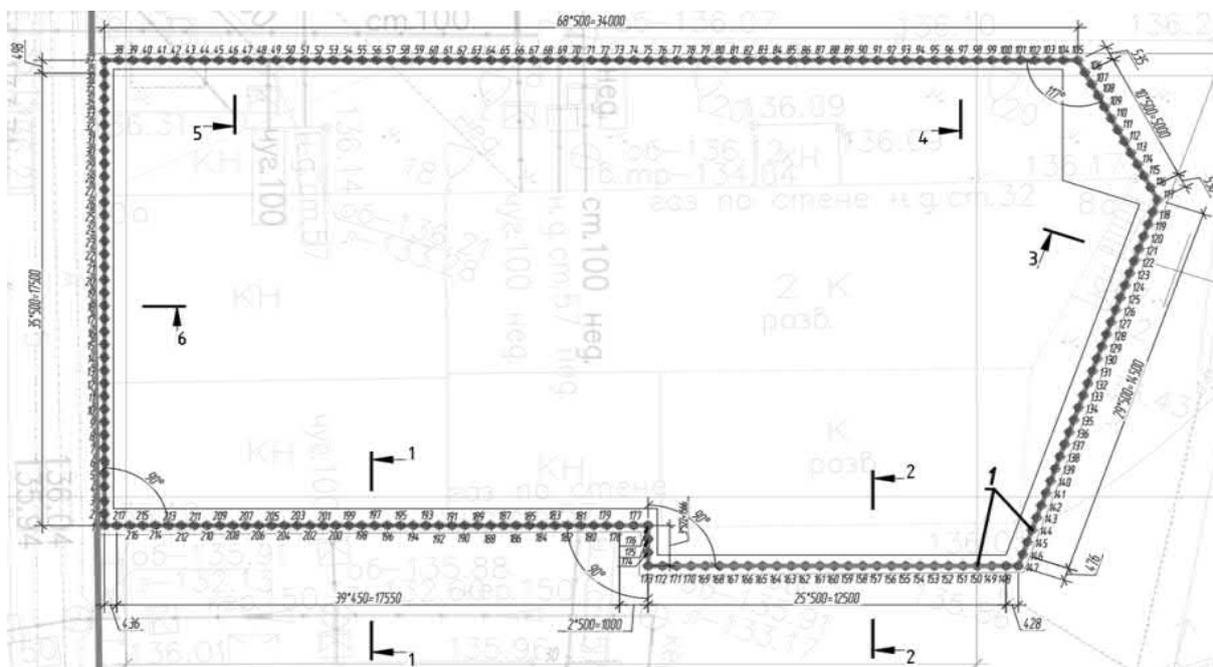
План расположения буринъекционных свай ЭРТ ограждения котлована
